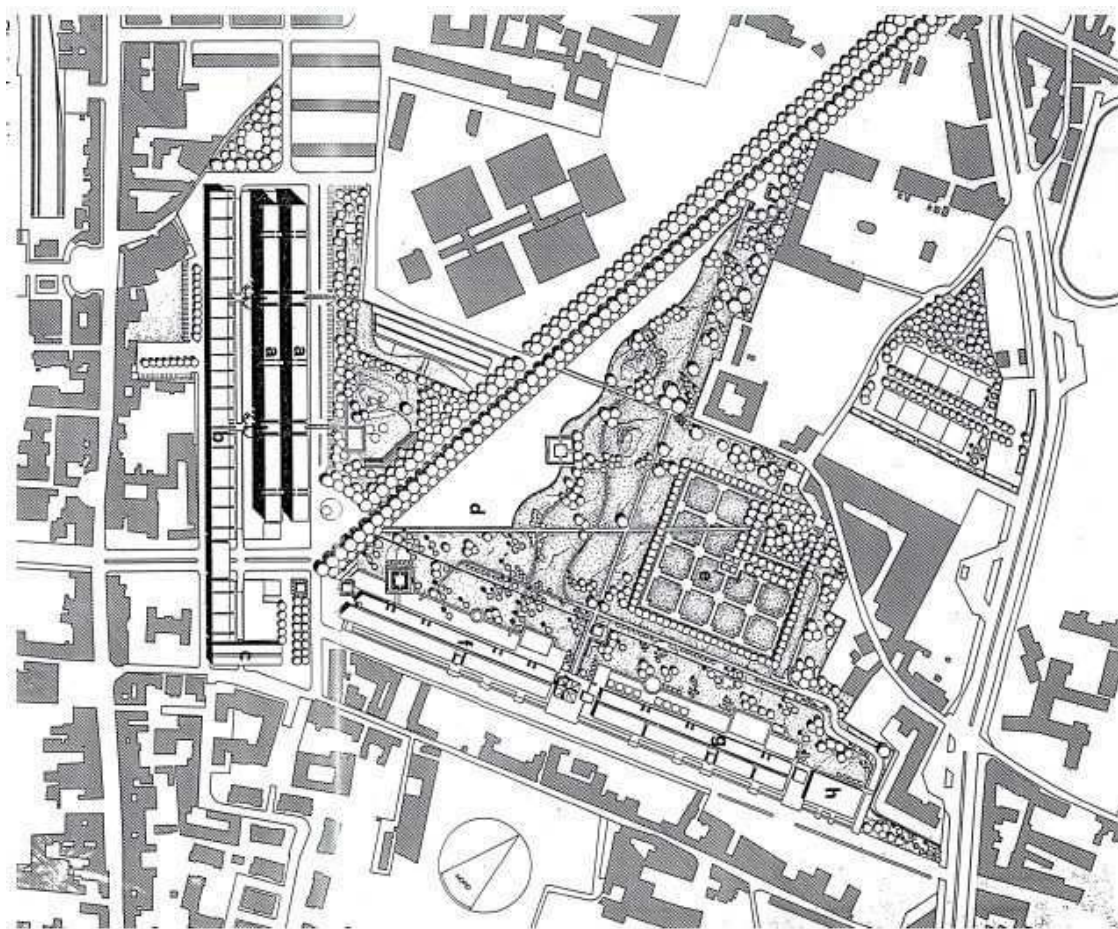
Planimetria generale dell'intervento di Taverna del Ferro a Napoli
